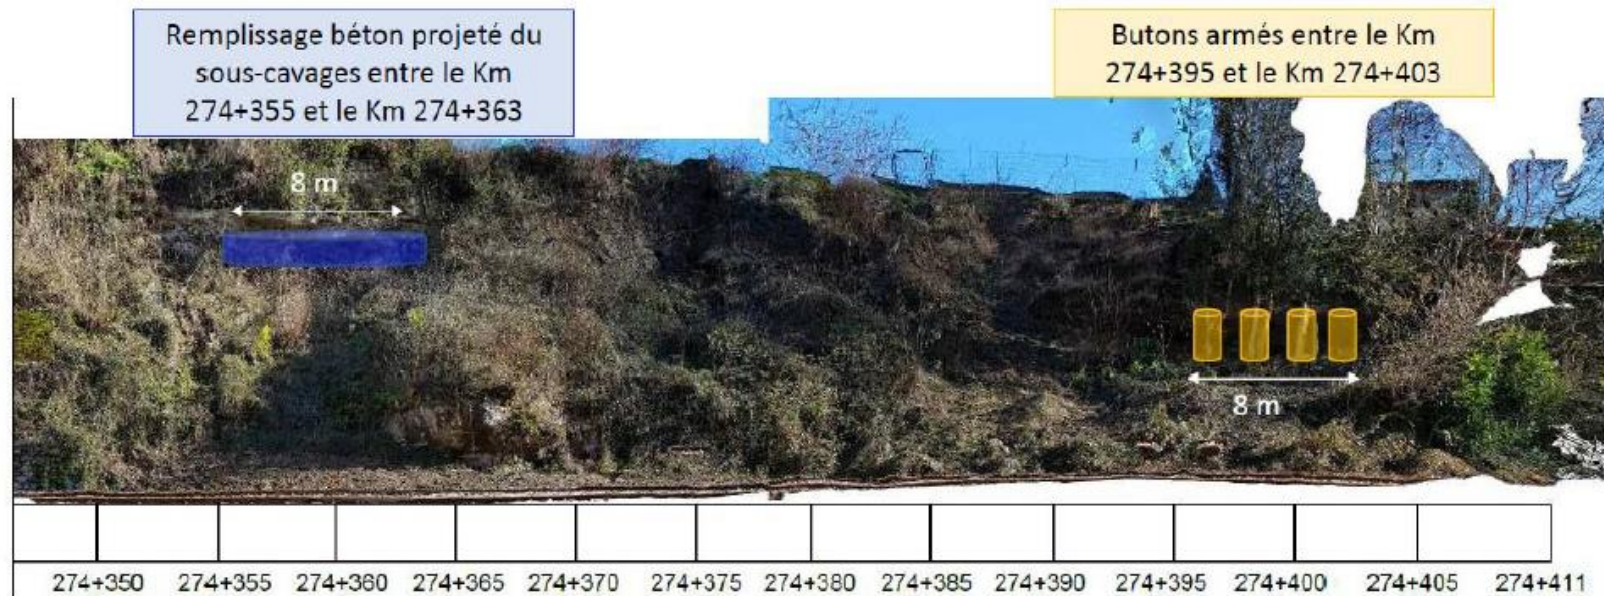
Panorama des travaux de confortement du secteur après le mur de soutènement du secteur 3
